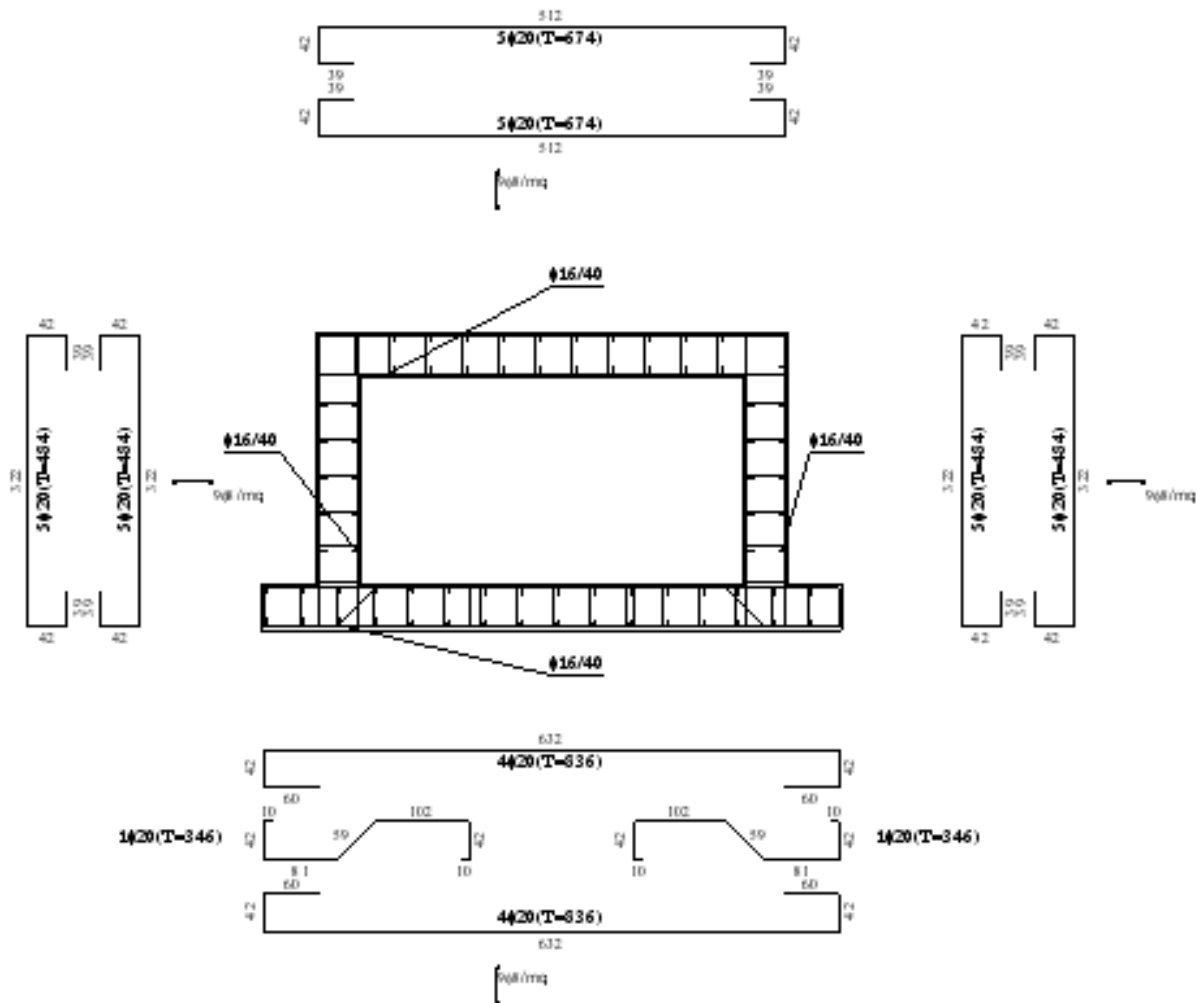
Schema delle armature, sezione tipo del canale di adduzione
